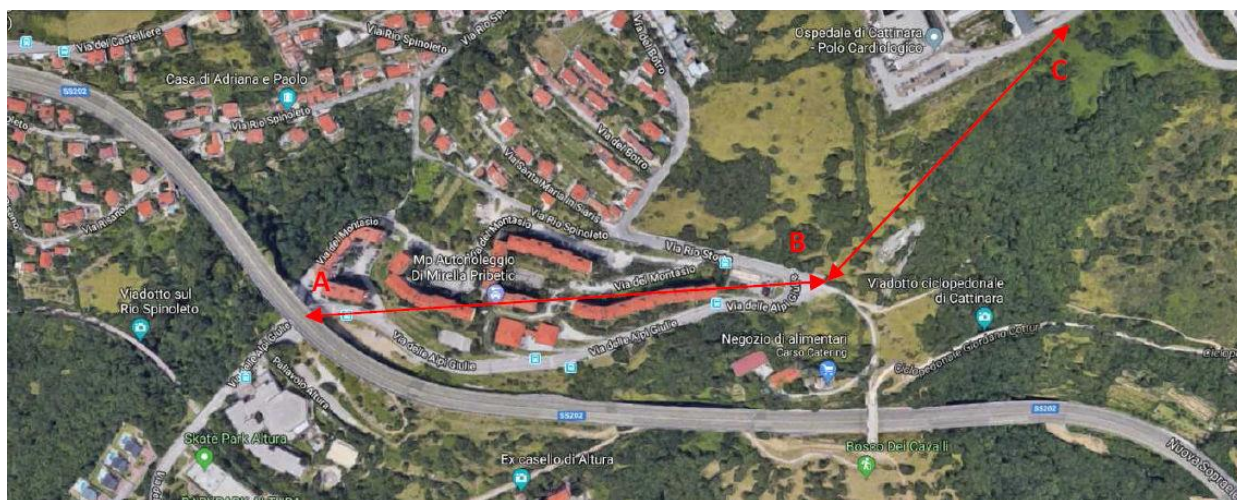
Ortofoto dell'area di intervento con lo schema del nuovo collegamento previsto
